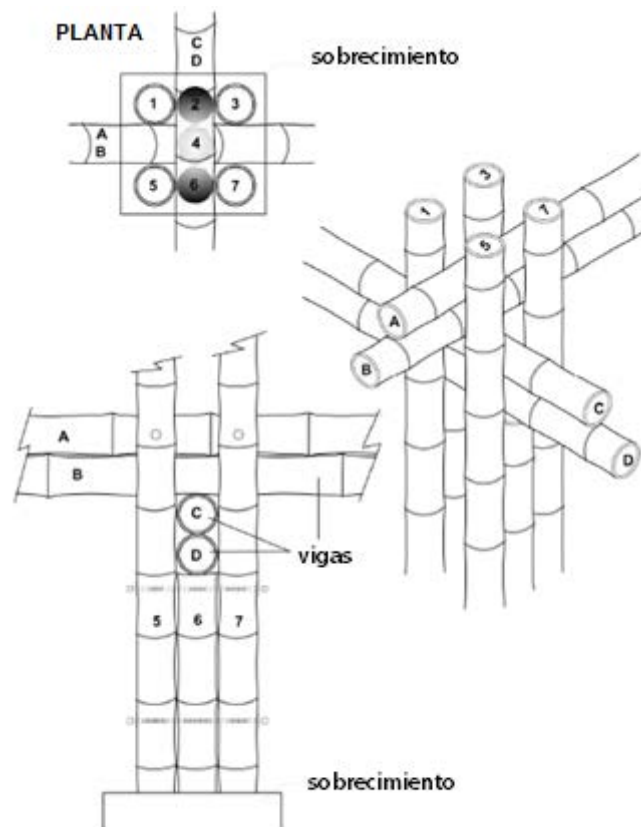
Columna compuesta por 5 culmos y que soportan vigas transversales
